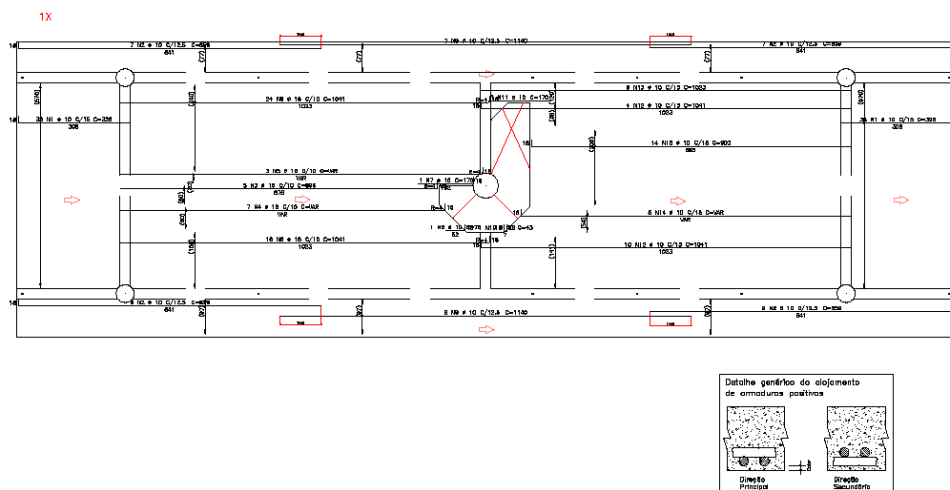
1º pavimento: armadura positiva principal. Fonte: AUTOR (2017).
